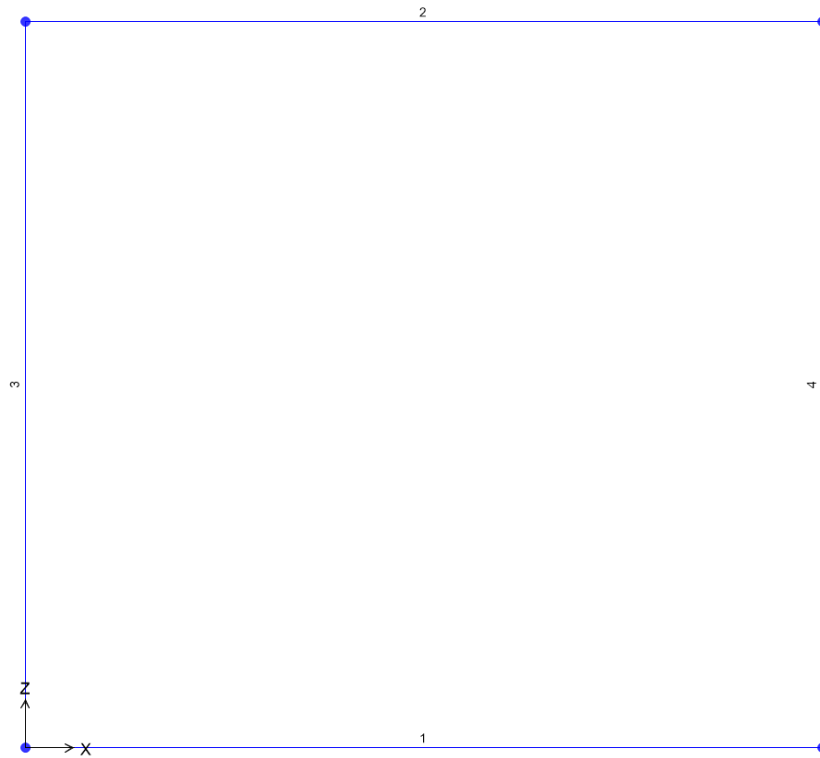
Numerazione degli elementi strutturali tipo beam
